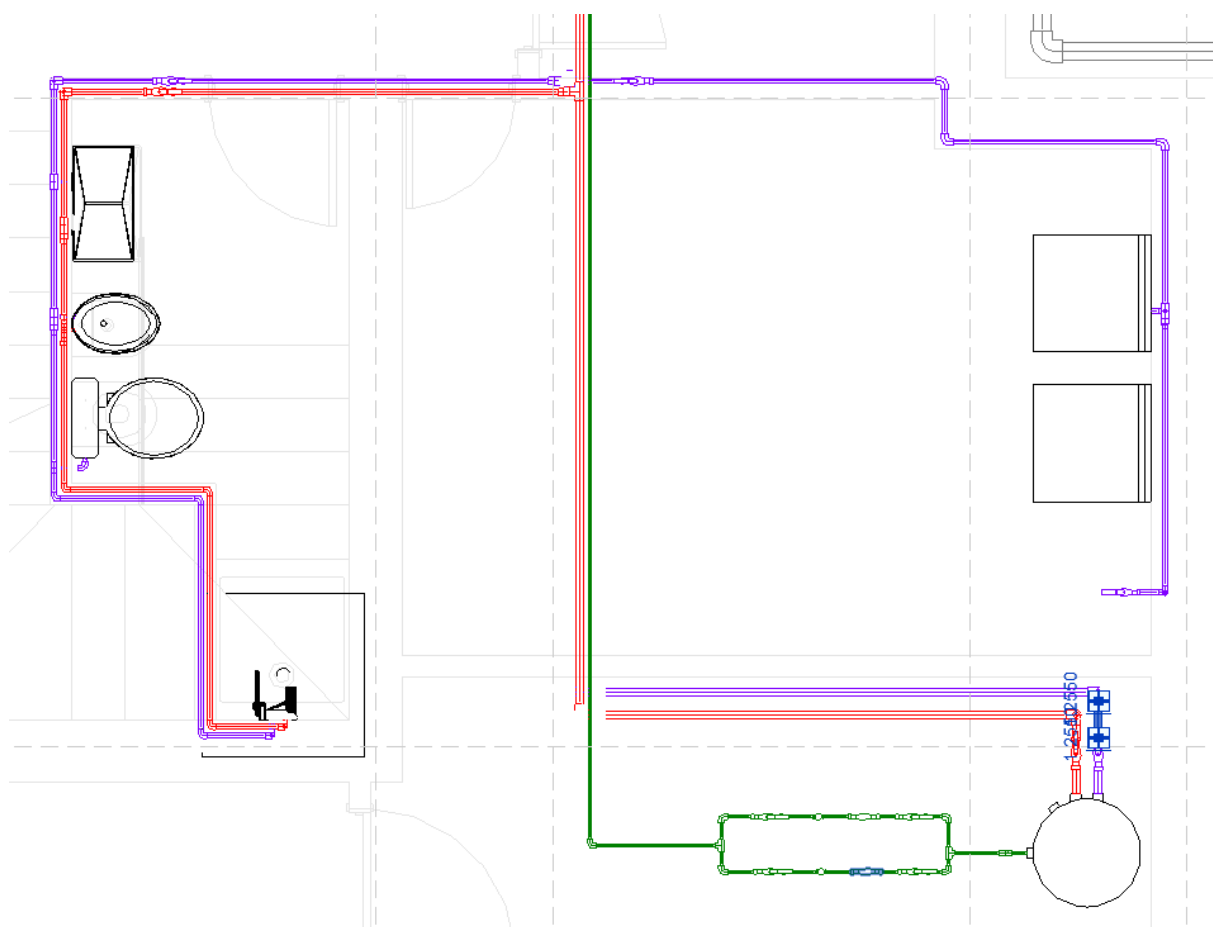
Divisão em planta do piso 0 da rede predial de abastecimento
